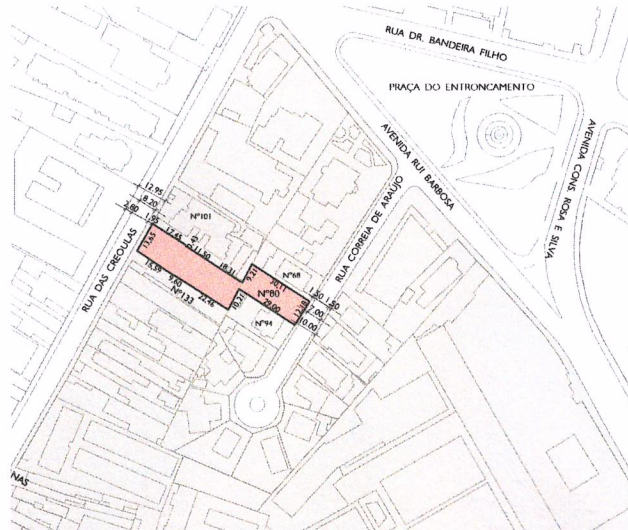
Localização do terreno do empreendimento. Fonte: projeto arquitetônico
